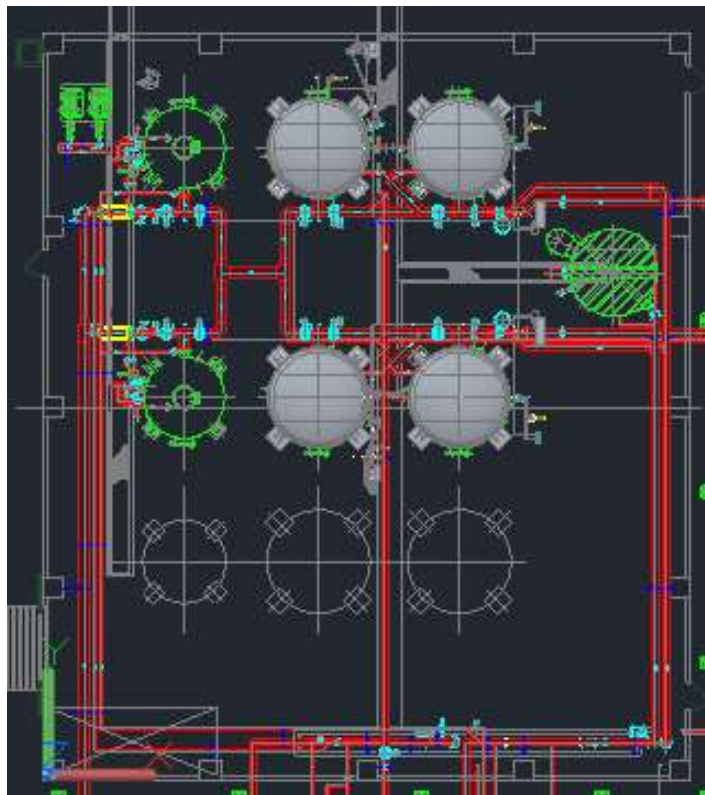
Vista planta del recinto con origen de coordenadas. El plano de layout se implantó en el proyecto a nivel de piso para referenciar las implantaciones [12].
